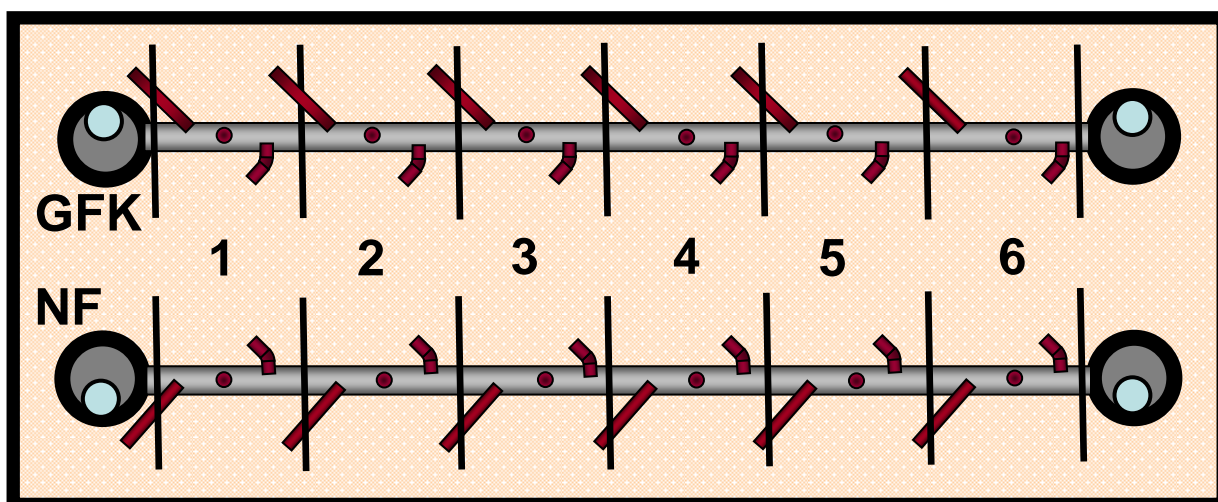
Skizze des Versuchsaufbaus bestehend aus den GFK- und NF-Linersanierten Betonrohr-Strängen mit jeweils sechs einzelnen Rohrabschnitten
